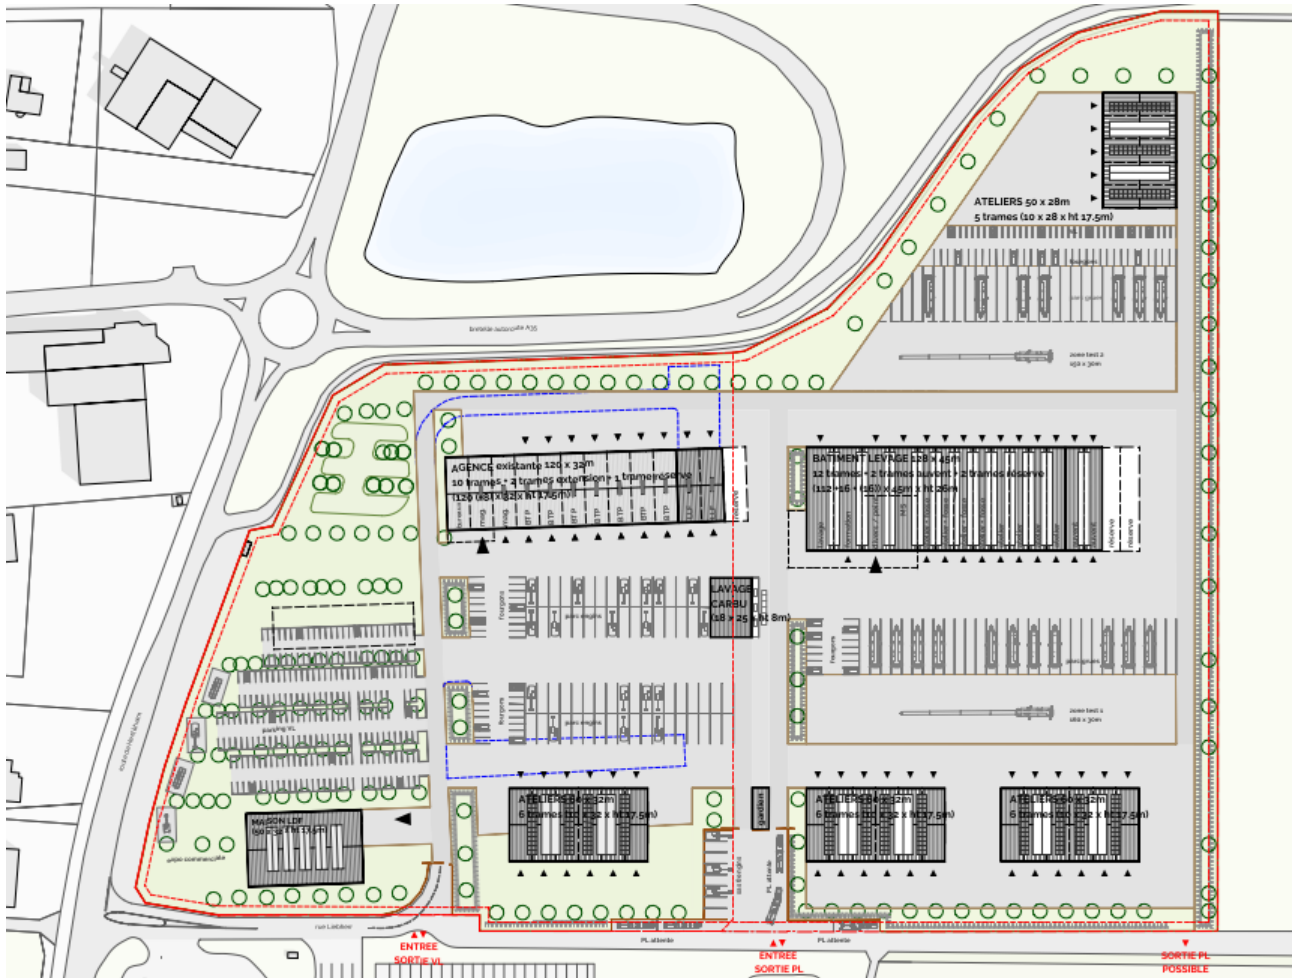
Plan de masse de l'organisation du site à moyen terme
